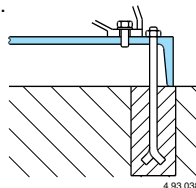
Fondazione per gruppo su piastra di base di profilato monolitico.
